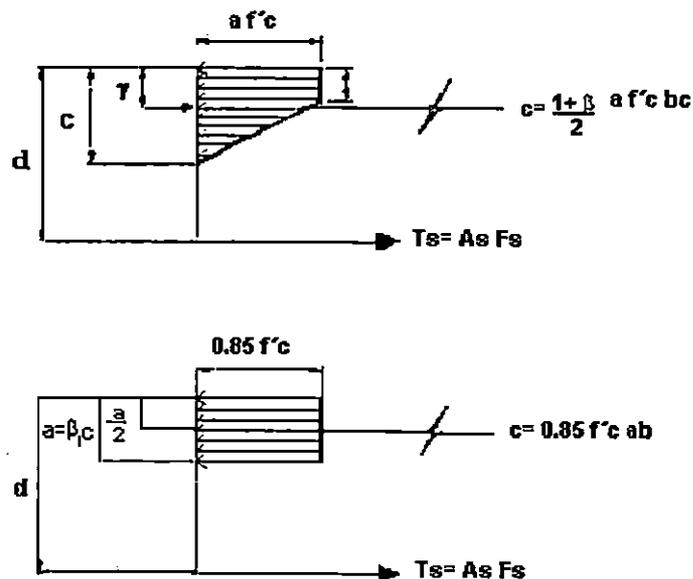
Distribución de Esfuerzos del Concreto Para Vigas Rectangulares.²⁶
